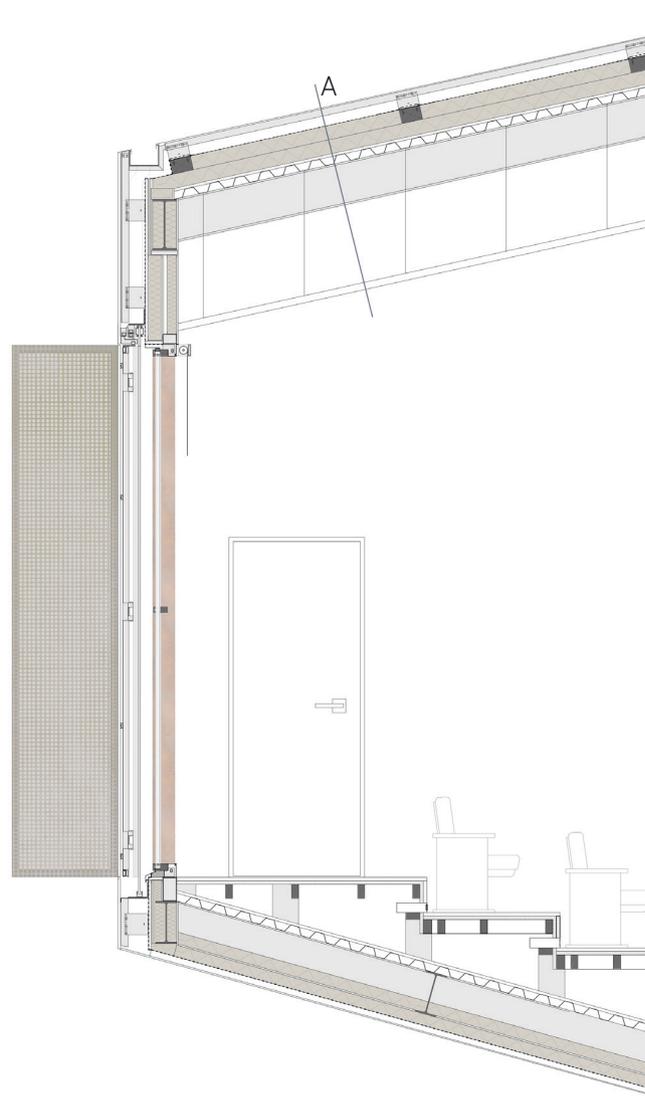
Prospetto e sezione della nuova facciata dell'auditorium in dettaglio
